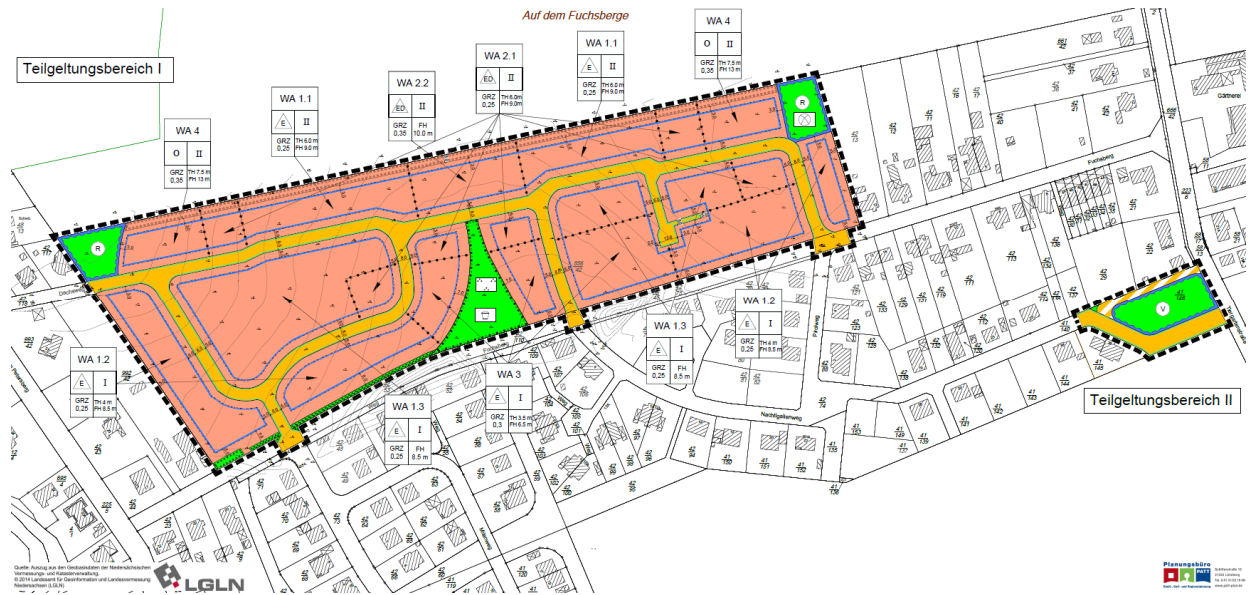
Planzeichnung zum Bebauungsplan „Fuchsberg Nord“ (Quelle: Planungsbüro Patt, Lüneburg)
